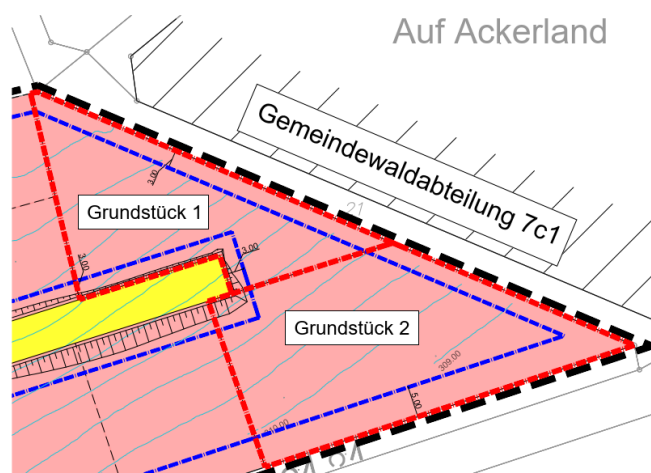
Lageskizze zur Identifikation der beiden von Windwurfgefahr betroffenen Wohnbaugrundstücke
